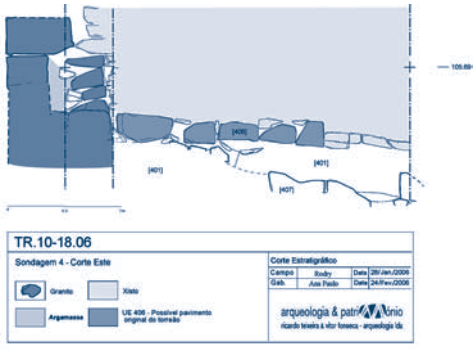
Alinhamento de pedras, possível pavimento original do torreão.
